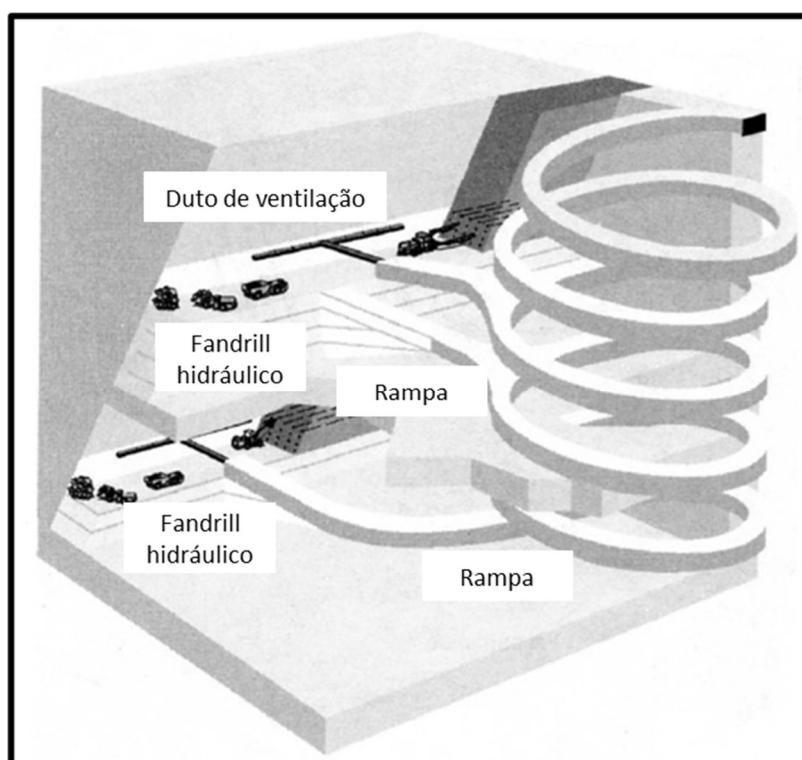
Ilustração Corte e Enchimento (Hamrin, 1986)
